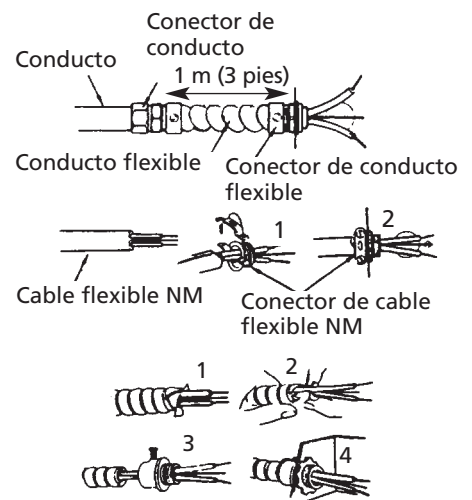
Conectores, Cable y Herrajes Utilizados para Cablear el Calentador
